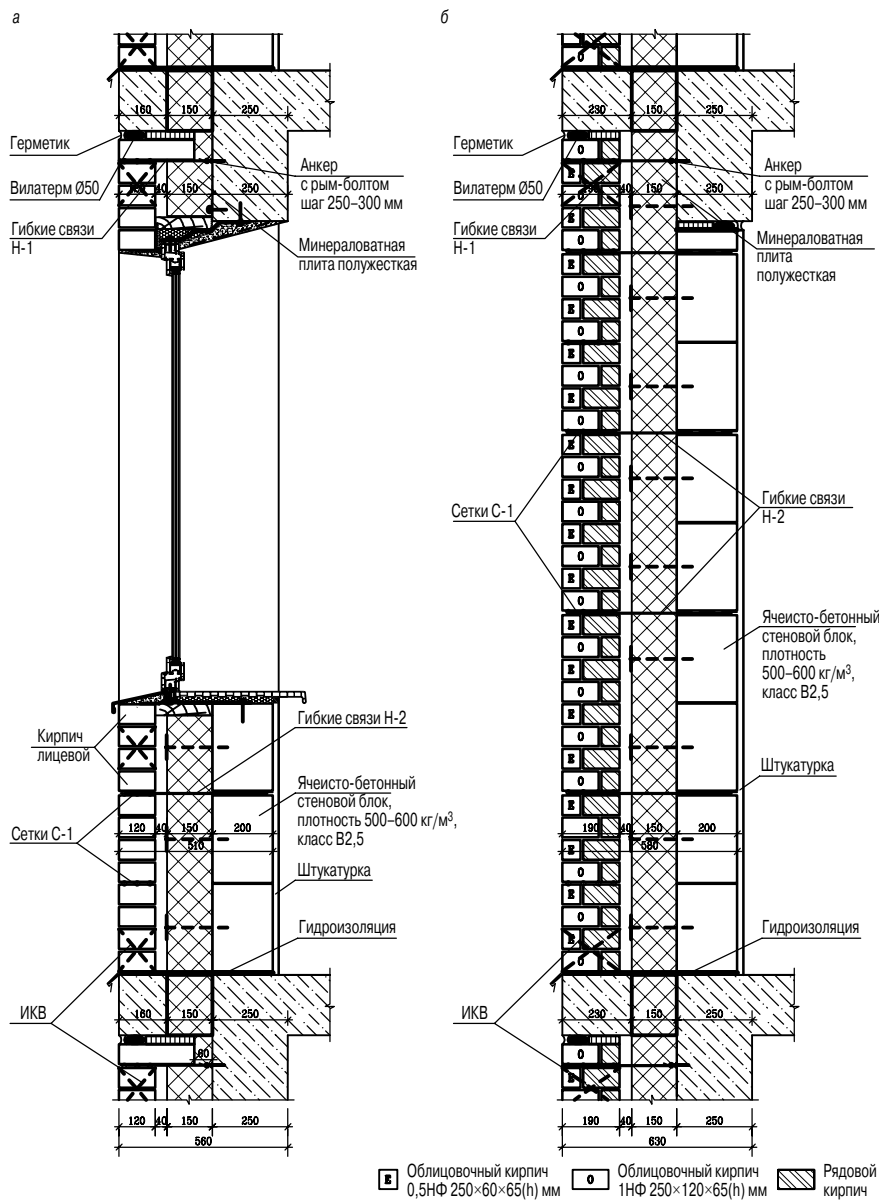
Наружная стена тип 1 с внутренним слоем из ячеисто-бетонных блоков, наружный слой толщиной: а – 120 мм; б – 190 мм
